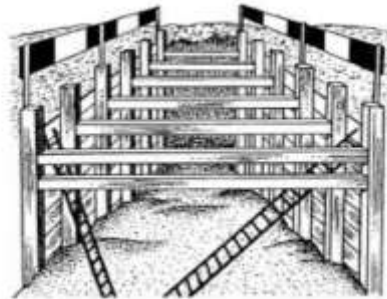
Barreras a ambos lados de una zanja, para impedir que los trabajadores caigan dentro de ella.
